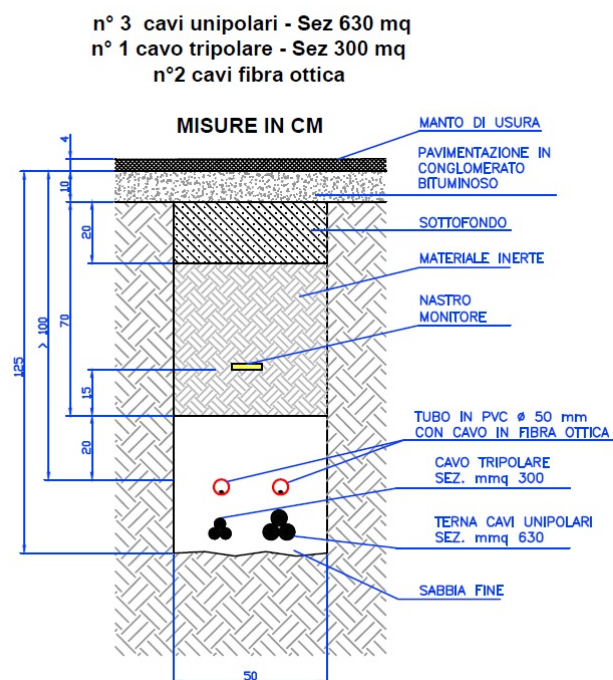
Sezione tipo cavidotto con doppia terna di cavi su strada asfaltata estraparco
